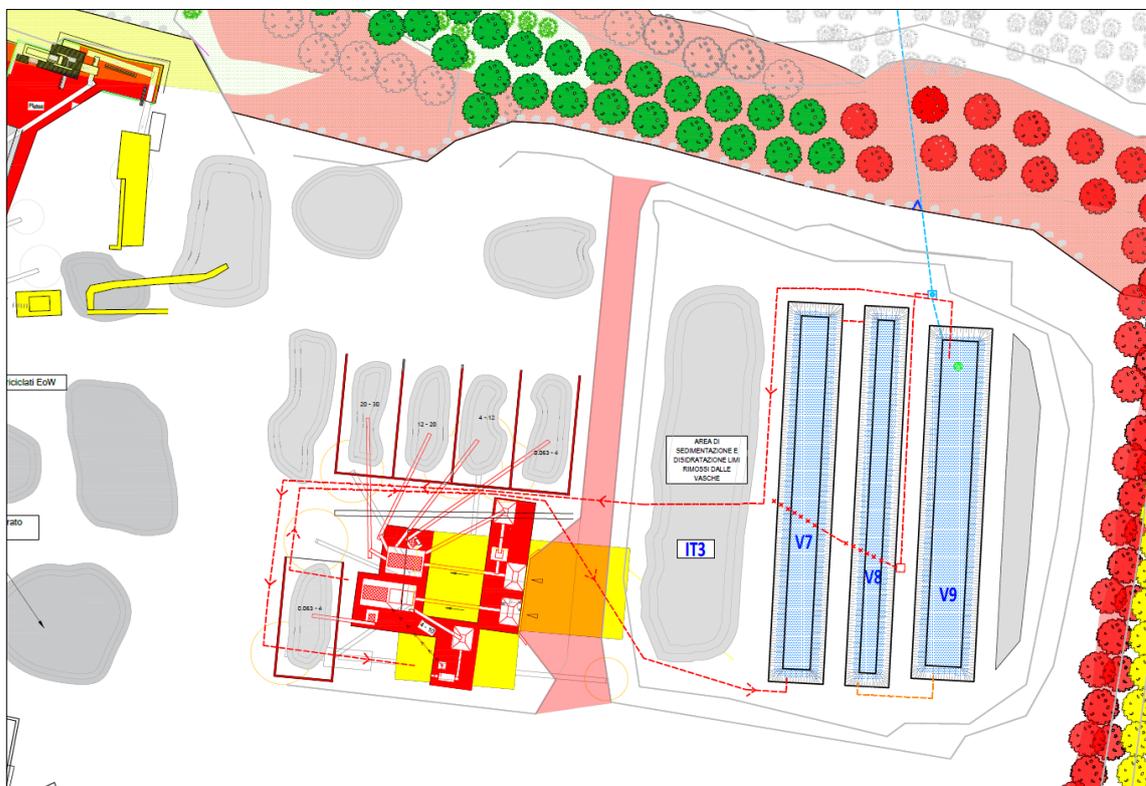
Estratto della tav. 5 - Planimetria generale - Stato sovrapposto autorizzato-variante [Ref 15]
